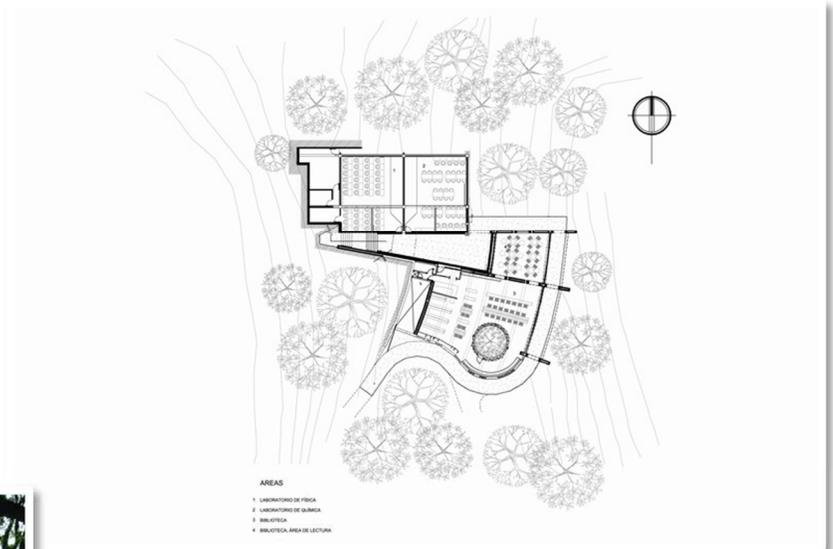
(Arriba) Plano Planta de laboratorios y biblioteca
